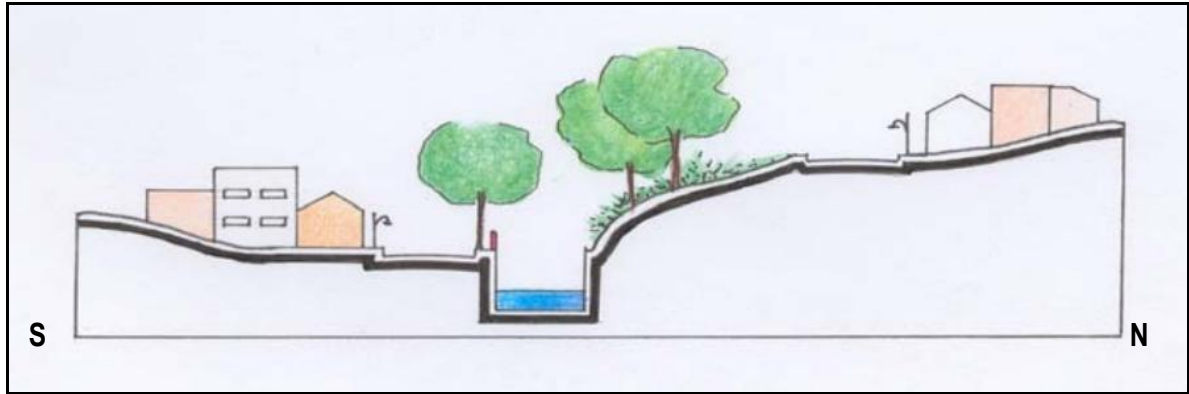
Corte esquemático do córrego do Gregório entre as ruas São Paulo e Rui Barbosa
